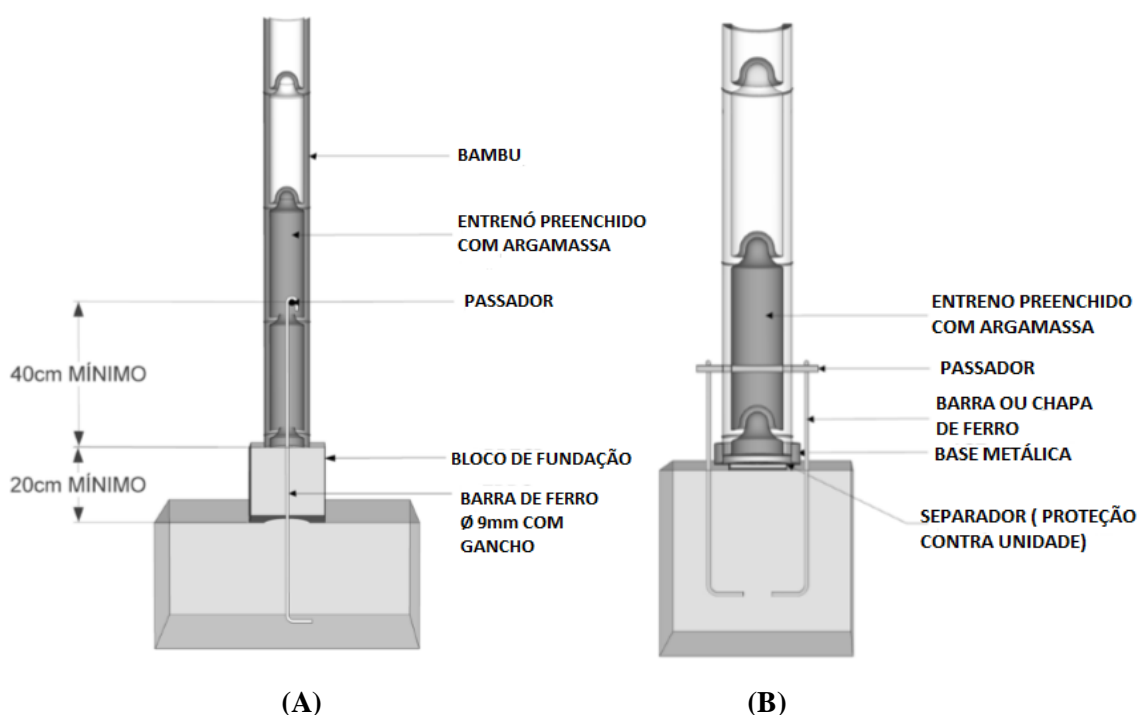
Figura 65a - Ligação interna coluna fundação. Figura 65b - Ligação externa coluna fundação. Fonte: Norma peruana NTE E.100 (2012) adaptada.
